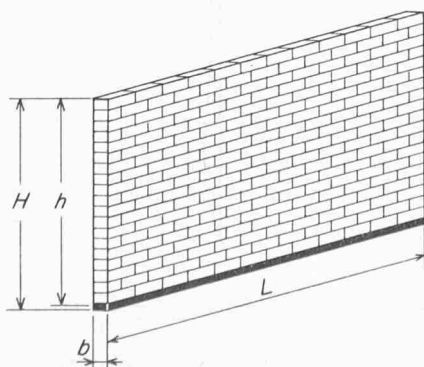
Selbsttragende Backsteinwand mit vorgespanntem Zuggurt
